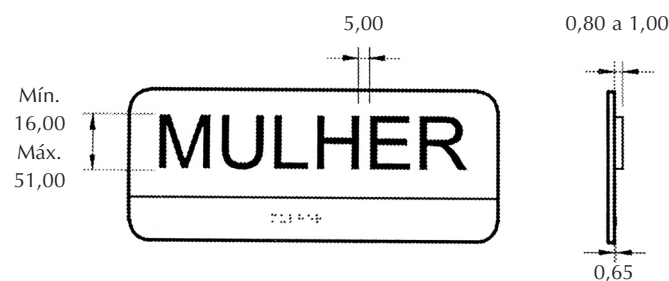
Sinalização tátil - vista superior e corte (dimensões em mm)
